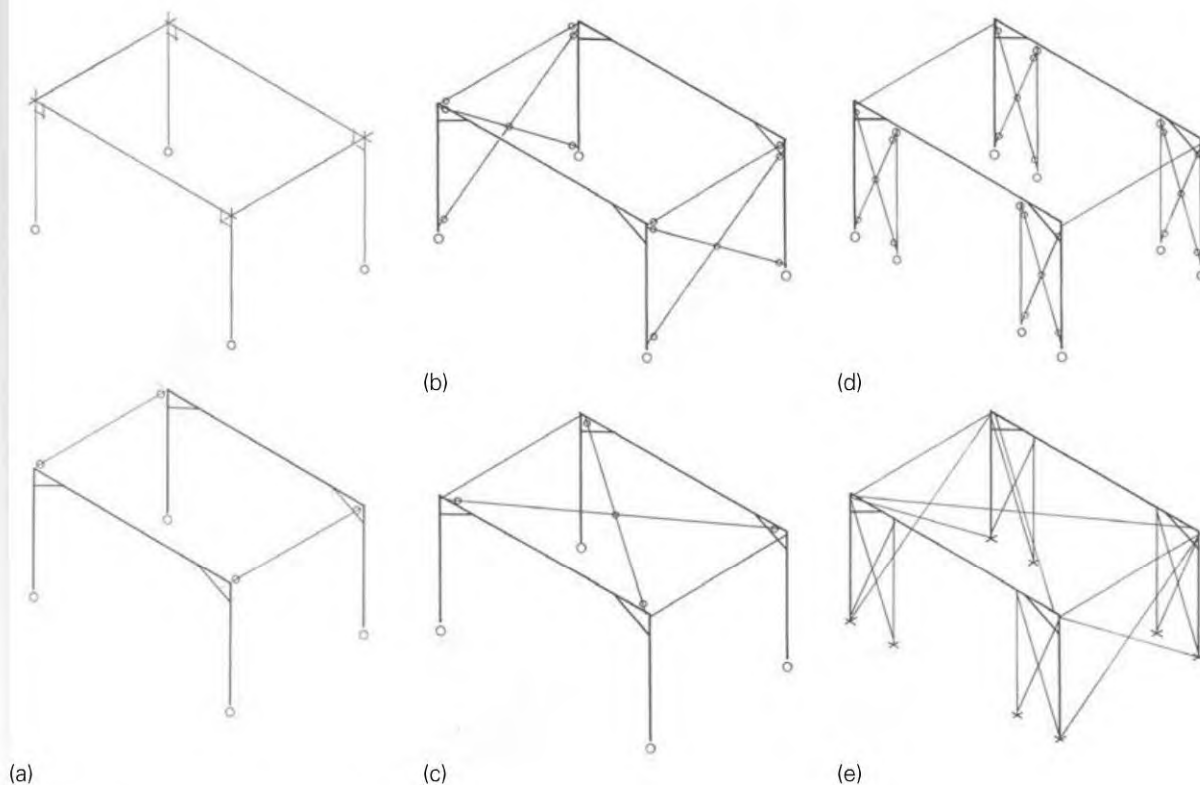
Scénario de la mise progressive en contreventement par plans d'un volume simple.
